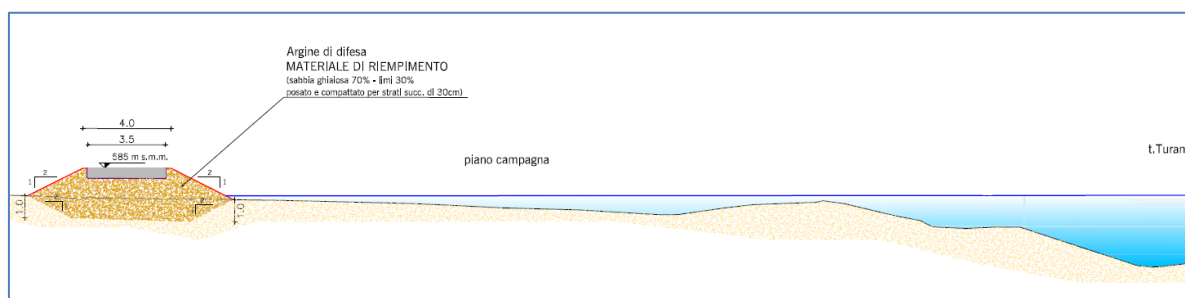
Sezione longitudinale dei rilevati arginali.
